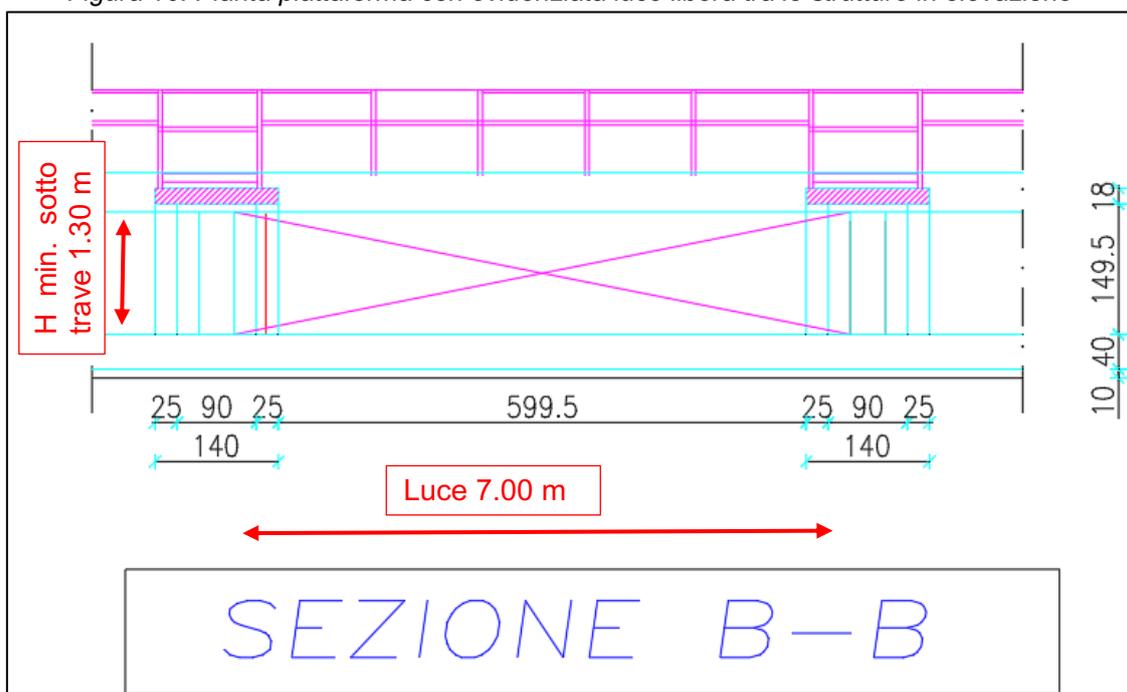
Sezione longitudinale B-B piattaforma sopraelevata
